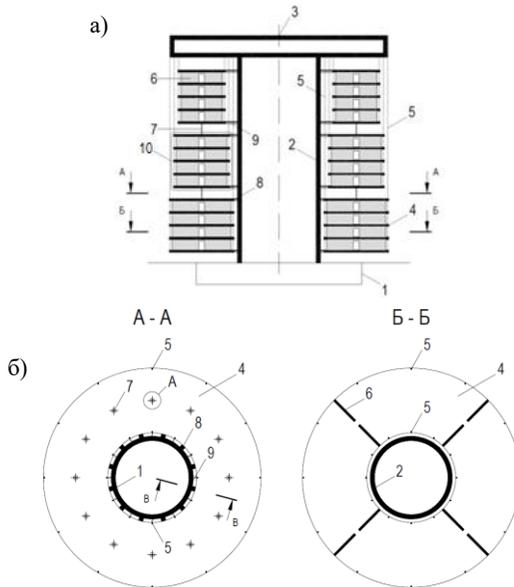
Предлагаемое конструктивное решение здания с подвешенными блоками этажей: а) вертикальный разрез; б) поперечные разрезы; 1 – фундамент; 2 – несущий ствол; 3 – оголовок; 4 – плиты перекрытий; 5 – подвески; 6 – диафрагмы жёсткости; 7 – включающиеся связи; 8 – выключающиеся связи; 9 – амортизаторы; 10 – блок этажей
